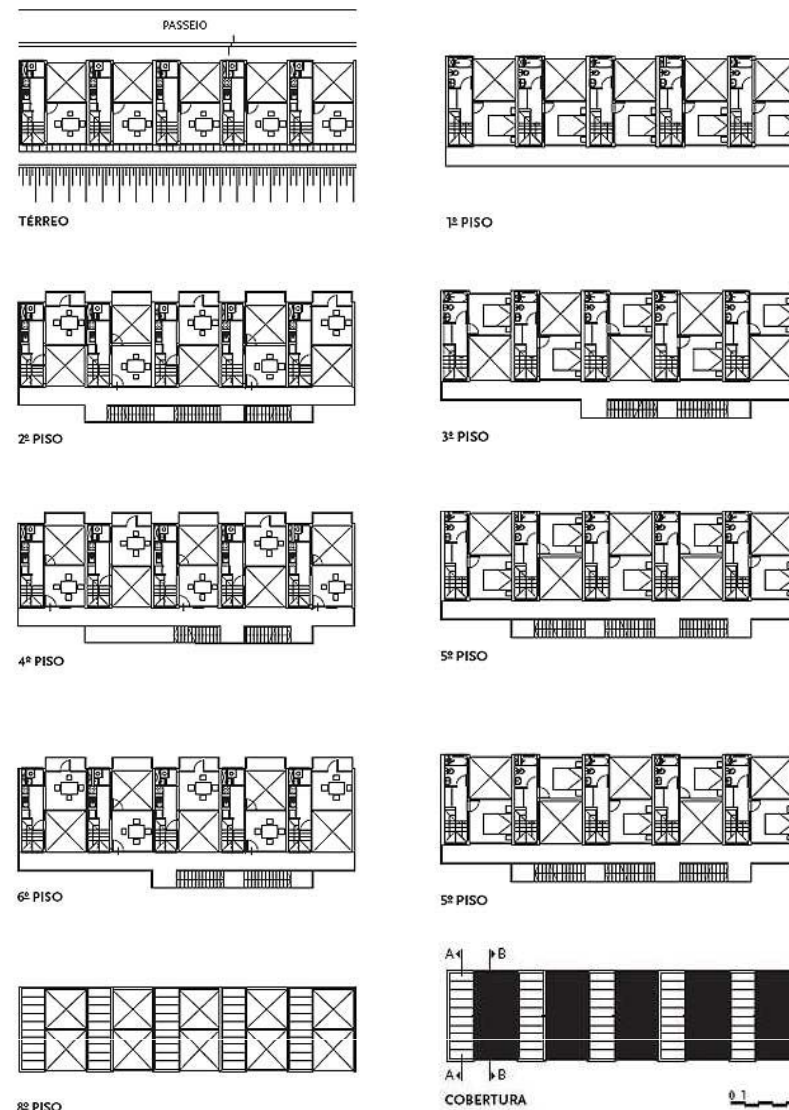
Plantas baixas dos blocos mostrando todos os pavimentos.
